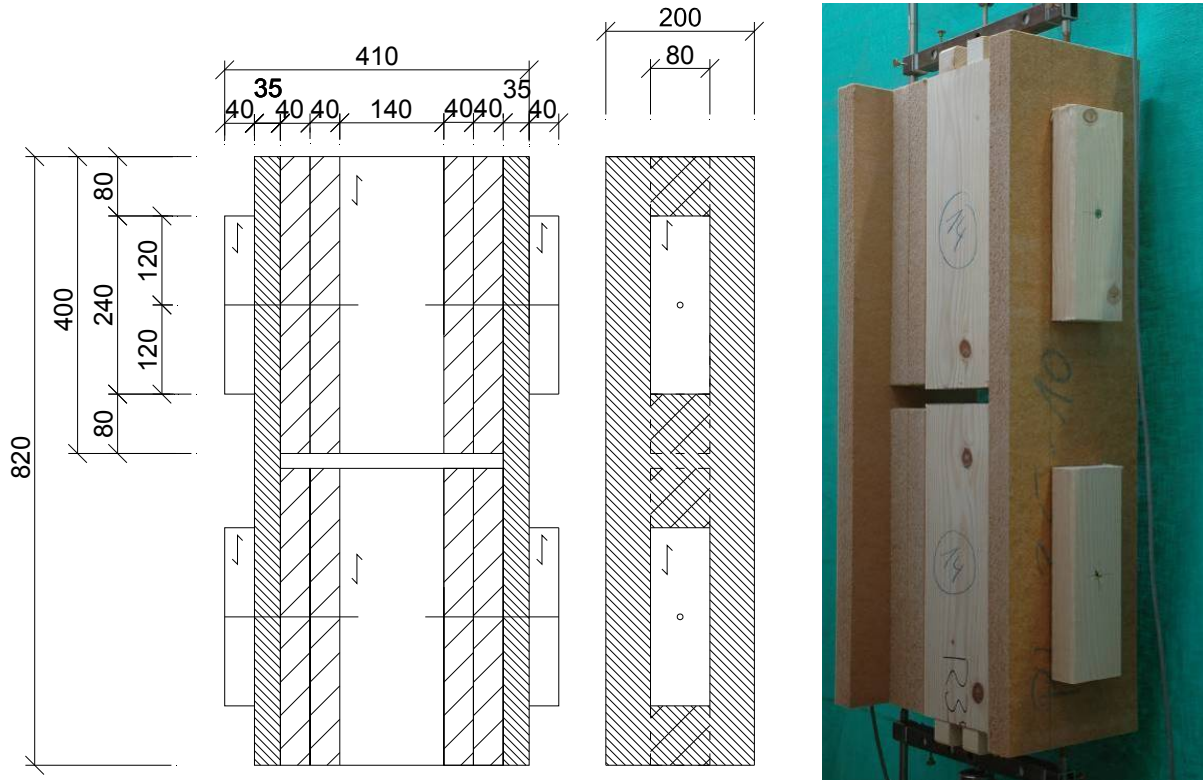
Zugscherkörper einer Holz-HFDP-Verbindung in einem zweilagigen Aufsparrendämmsystem (Dämmschicht 2 x 40 mm, Maße in mm)
